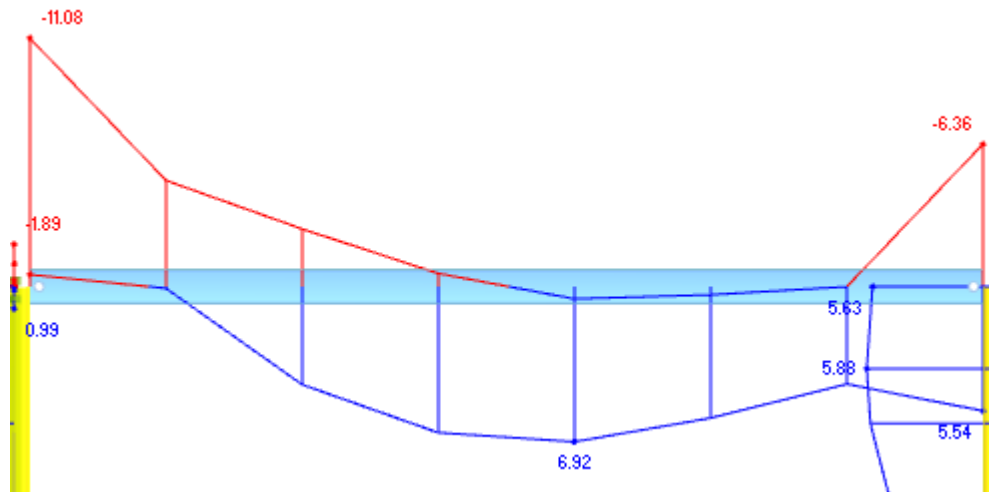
Módulo arriostrado de base rígida y unión viga pilar rígida.
